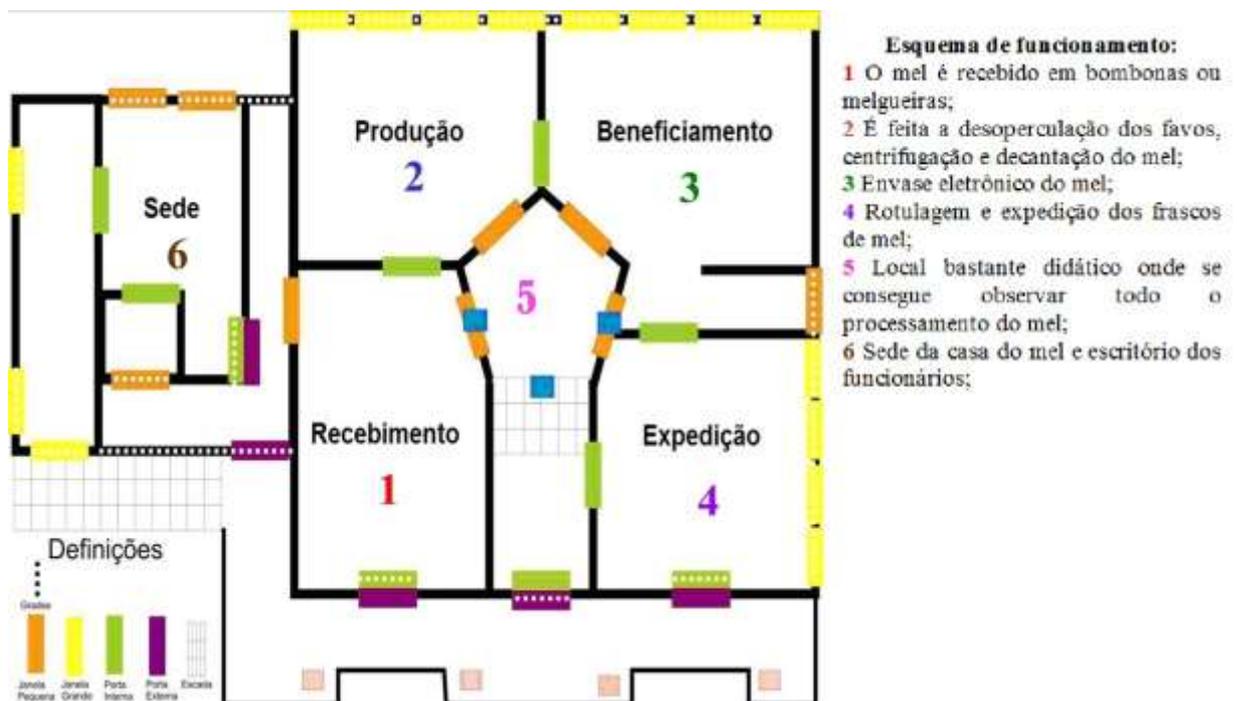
Planta baixa da Casa do Mel da Associação Gaúcha de Apicultores.
